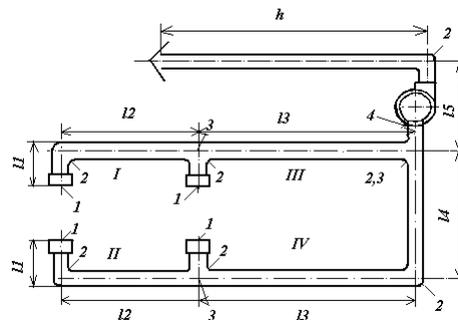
Схема к расчёту вытяжной сети системы вентиляции.
